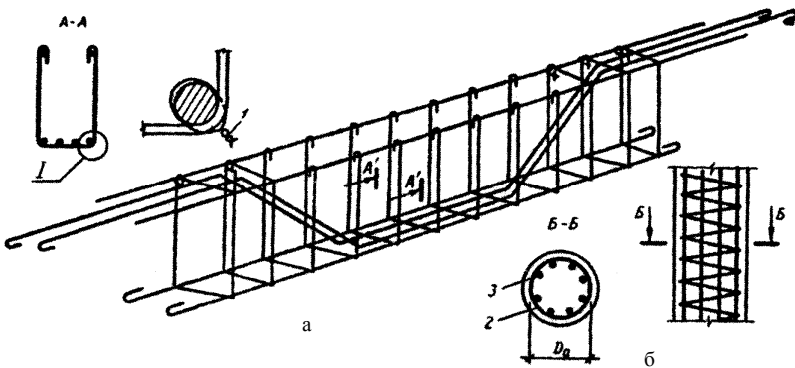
Арматування конструкцій окремими стержнями:
